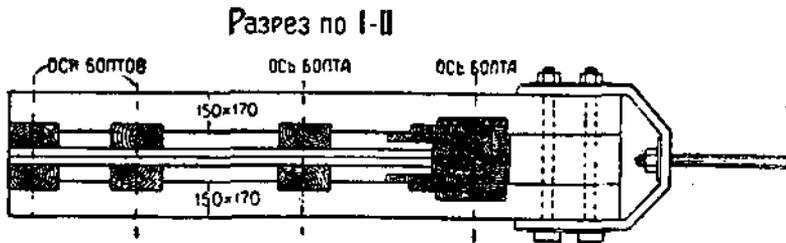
, 533 и 534 проект фермы системы Стефан над машинным залом Центральной электрической станции на Фонтанке, в Ленинграде; пролет 25 м; пояса составлены, как и на фиг. 531, из нескольких тонких
